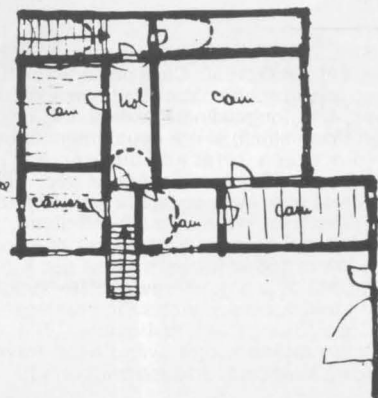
Str. T. Vladimirescu, nr.2 -plan
